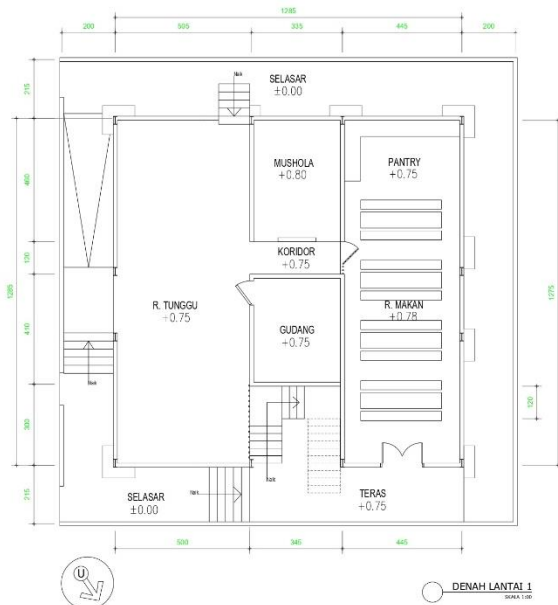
Gambar Sketsa dan Gambar Kerja Denah Gedung Relokasi Sementara
